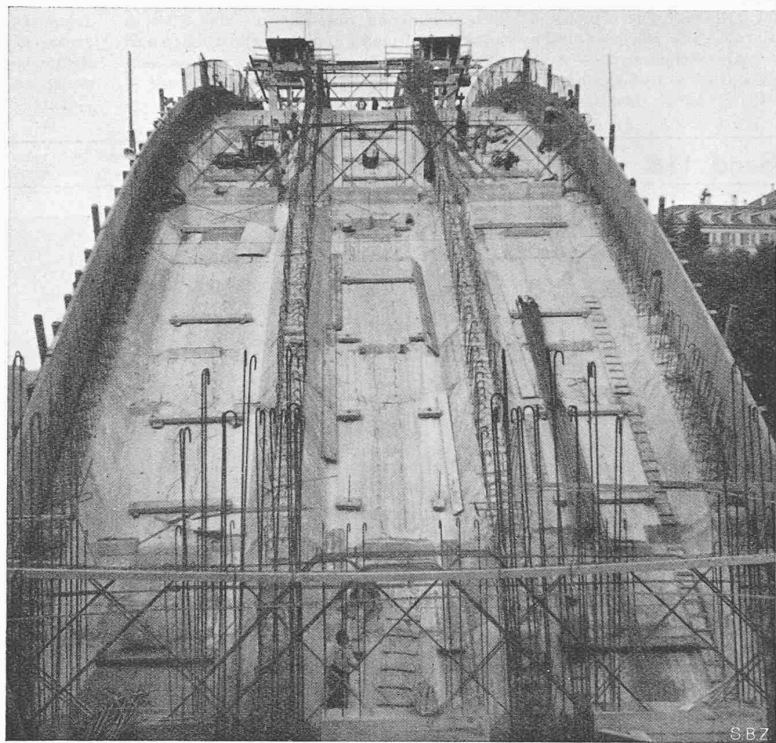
Erster Ring betoniert, mit Bewehrung der Querschotten
